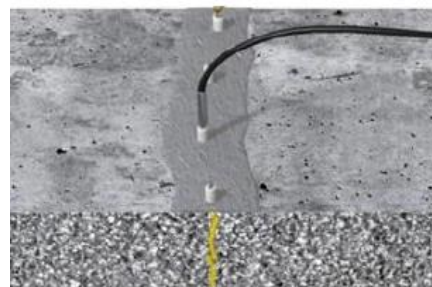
Fissura selada pronta para injeção com injectores de superfície [15]
